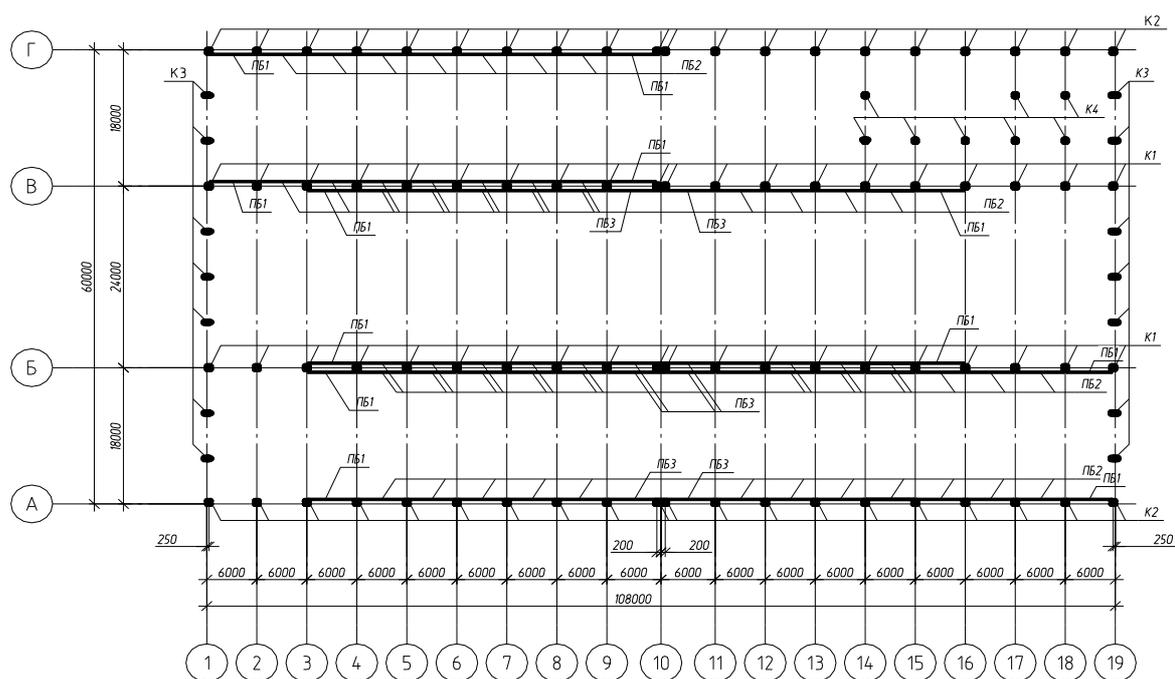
Схема расположения колонн и подкрановых балок
